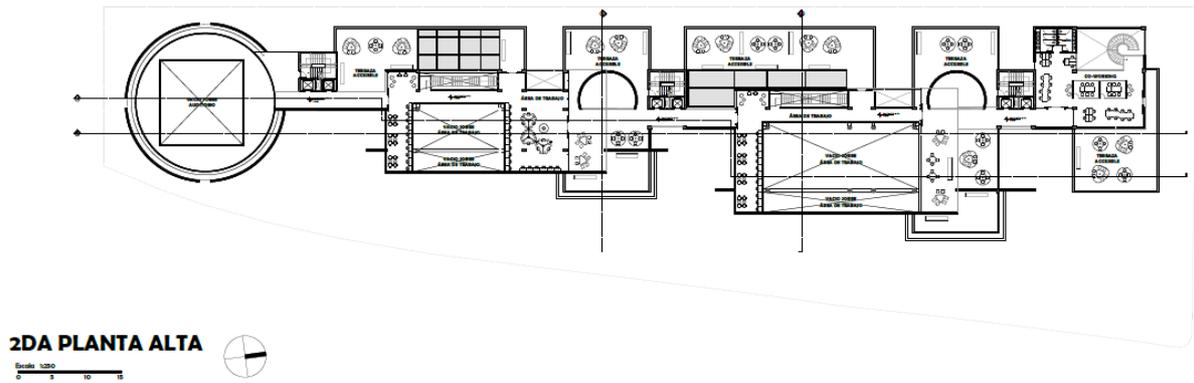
Segunda Planta Alta CRAI. Elaboración Propia.
